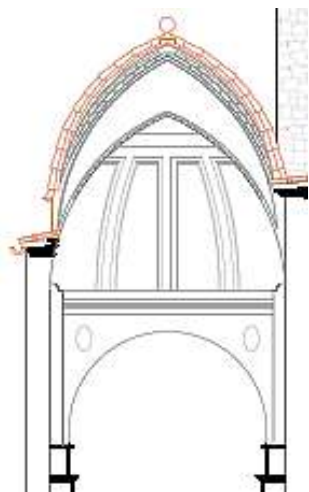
Detalle de la cúpula en sección. Imagen propia 20/08/17
